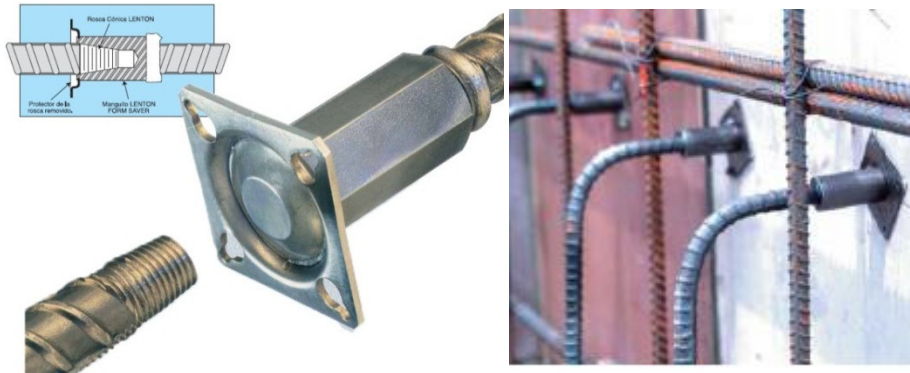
Conector espigado (izquierda), instalado en obra, dentro del moldaje (derecha).
